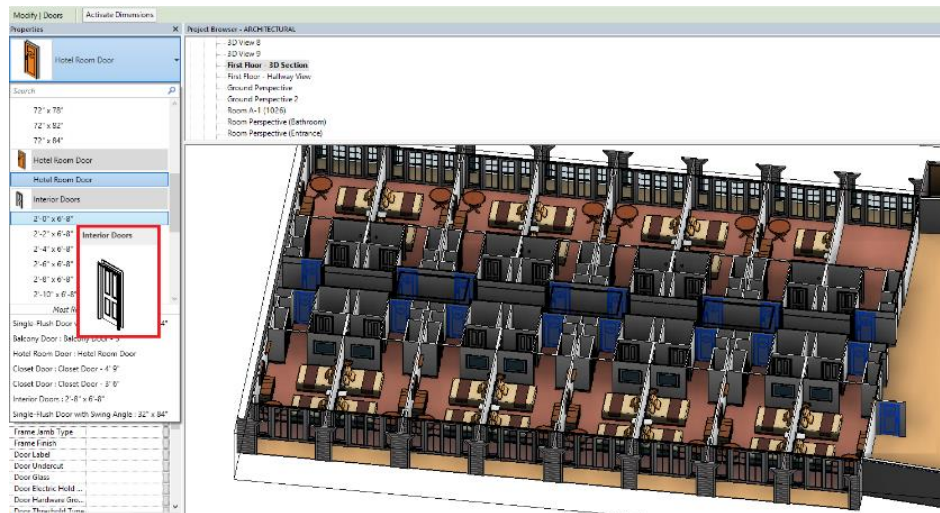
Alteração do tamanho e tipo de portas no projeto de arquitetura
